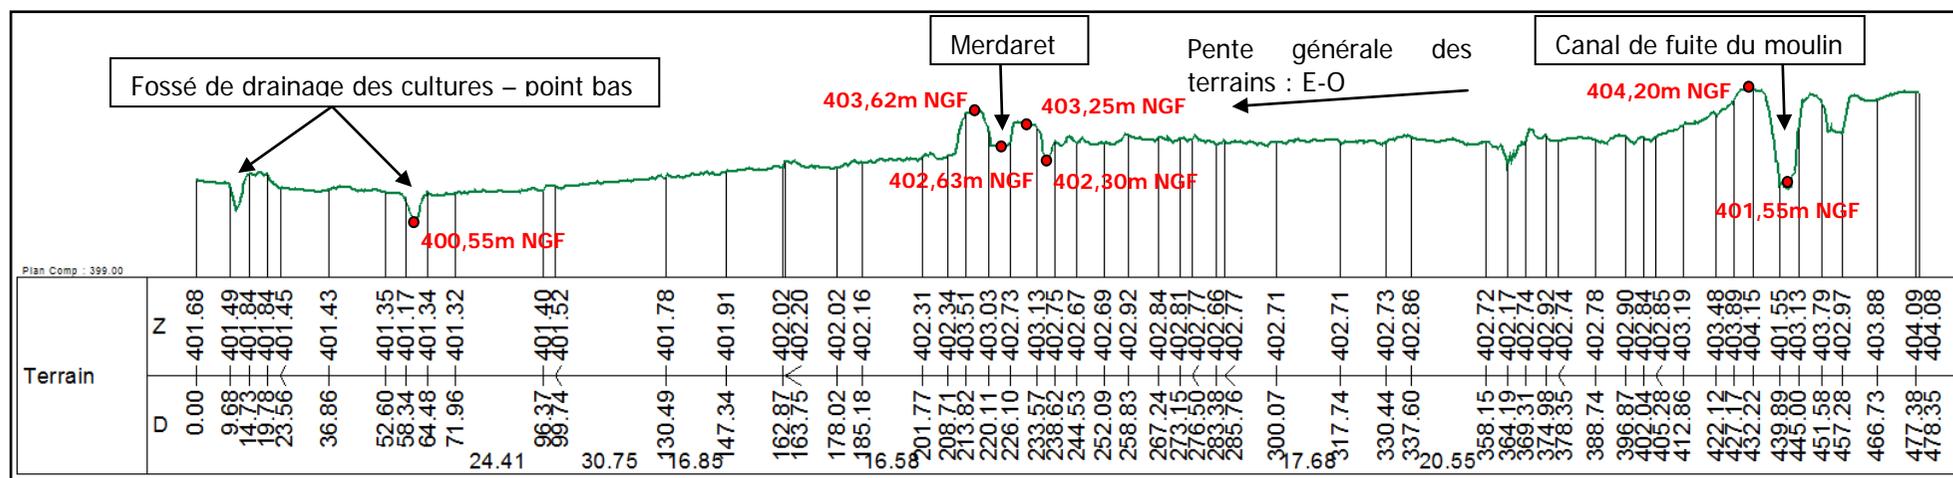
Profil en travers de la plaine alluviale du Merdaret (Echelle en Z : x10)
